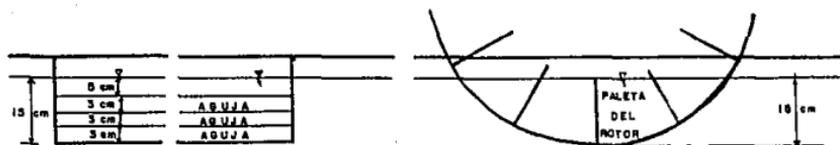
AGUJAS INSTALADAS EN EL VERTEDOR
